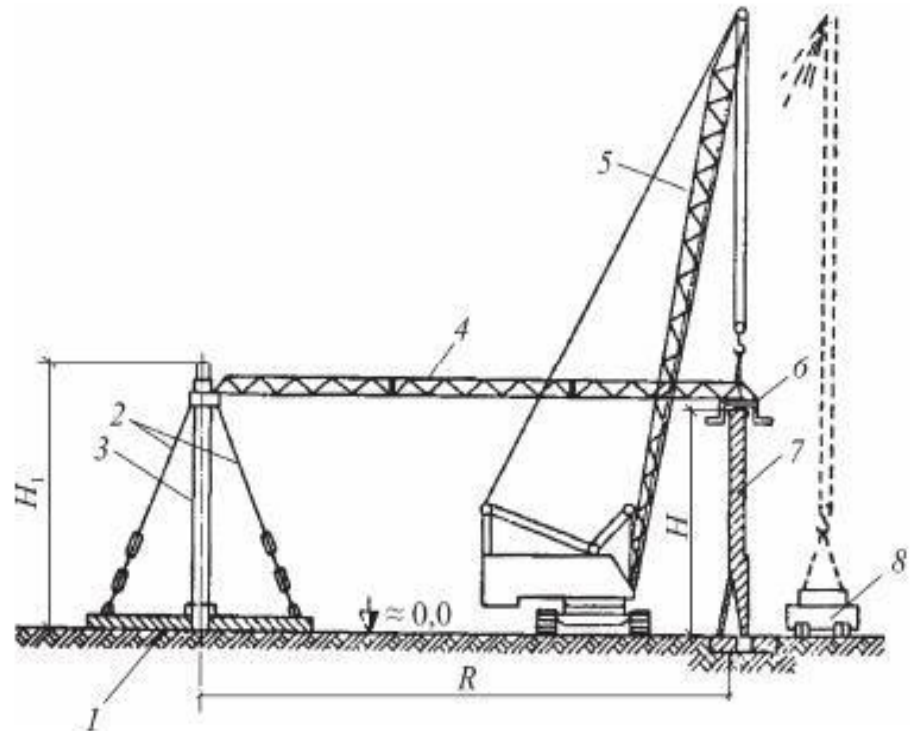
Схема подвижного кондуктора для монтажа железобетонных панелей опускного колодца: 1 – фундамент мачты кондуктора; 2 – растяжка; 3 – мачта; 4 – поворотная раппорка; 5 – монтажный кран; 6 – опорная часть конструкции; 7 – железобетонная панель; 8 – панелевоз
